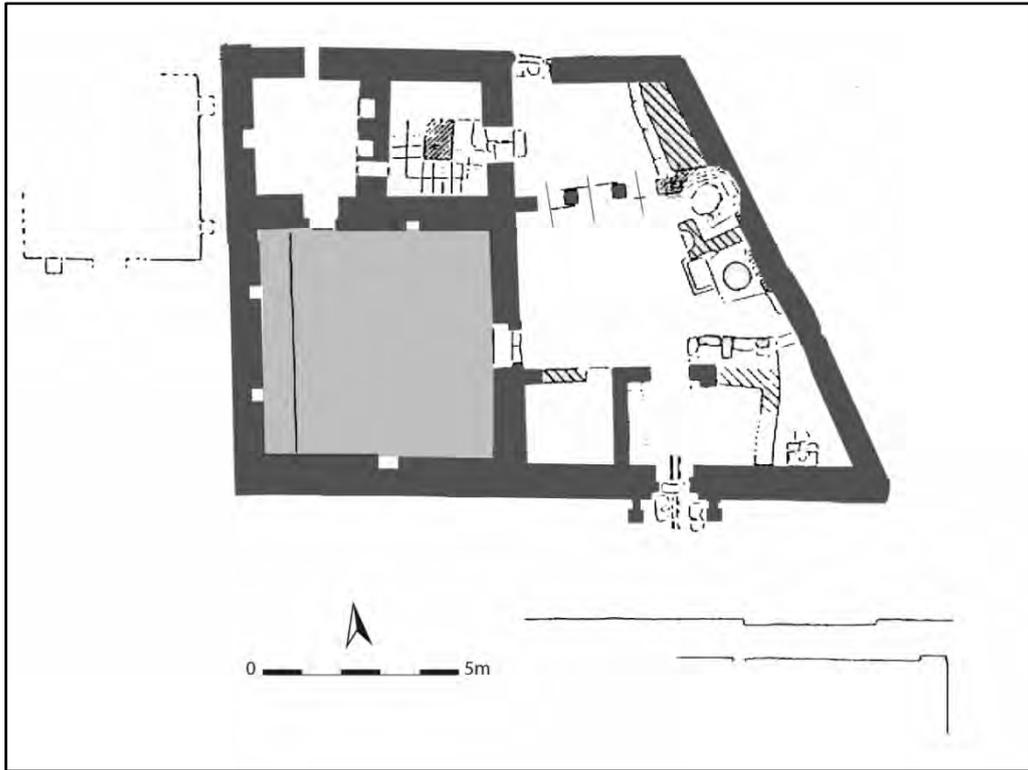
Abu Mina: planimetria dell'abitazione detta "*Domed House*" (VI-VII d.C.).
